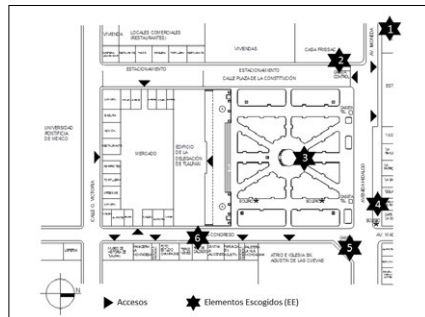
Proyección en planta de la Plaza con los elementos empleados en la fotoentrevista. Elaboración del autor.
